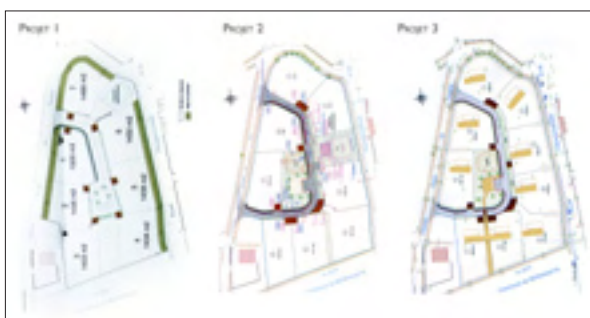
Bernadets – Plans DEGEORGES & LABOUDETTE GÉOMÈTRES
